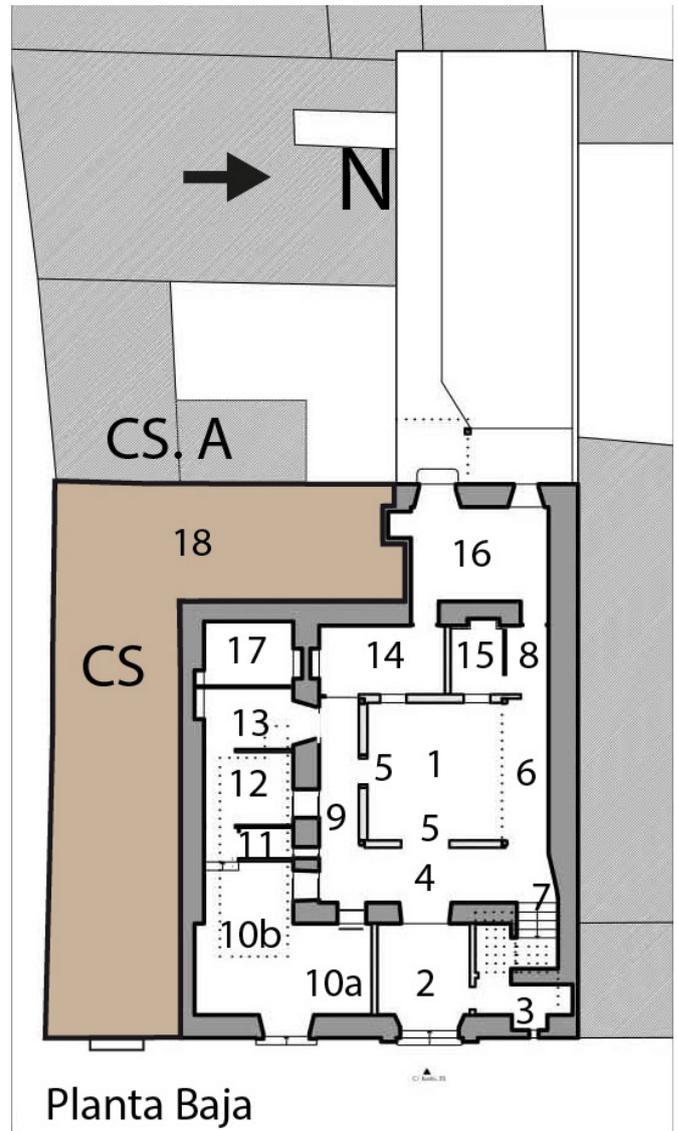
Plano de la planta baja, a partir del levantamiento de D. Alberto J. García Martos.
